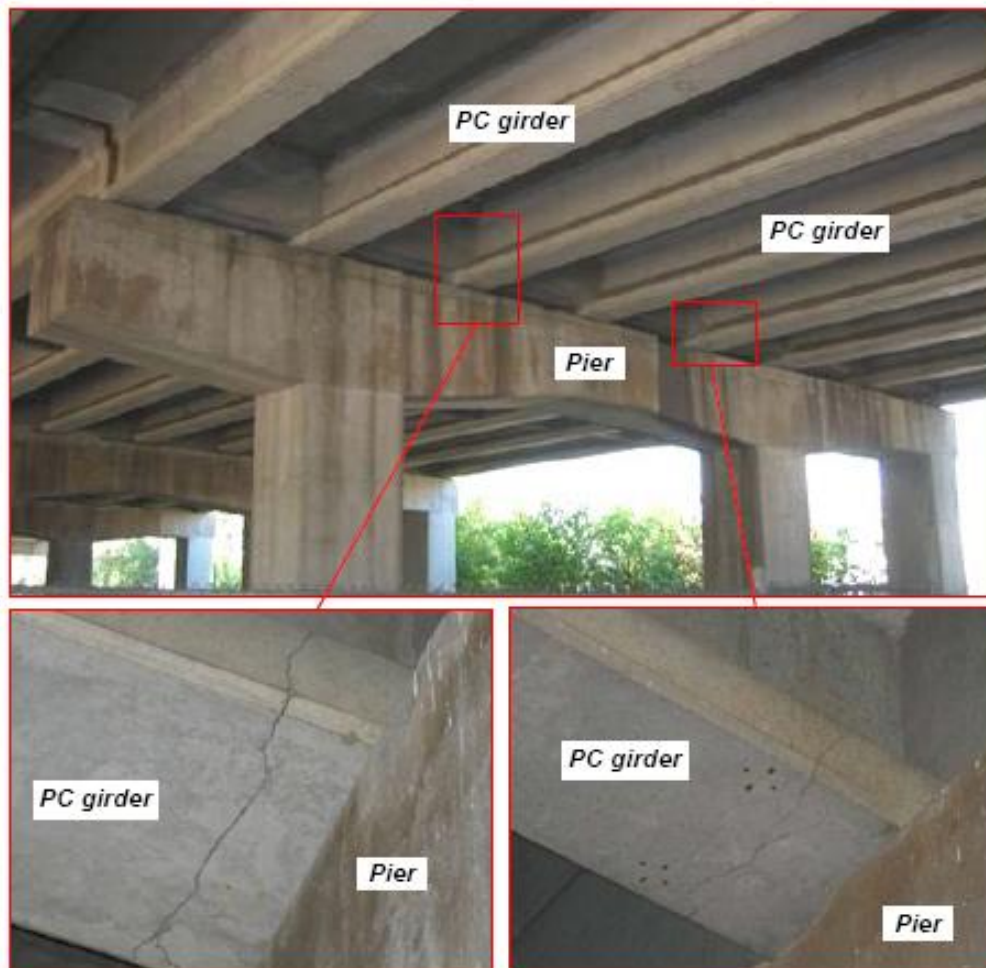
Fissuration dans les travées de poutres en béton précontraint [7].
